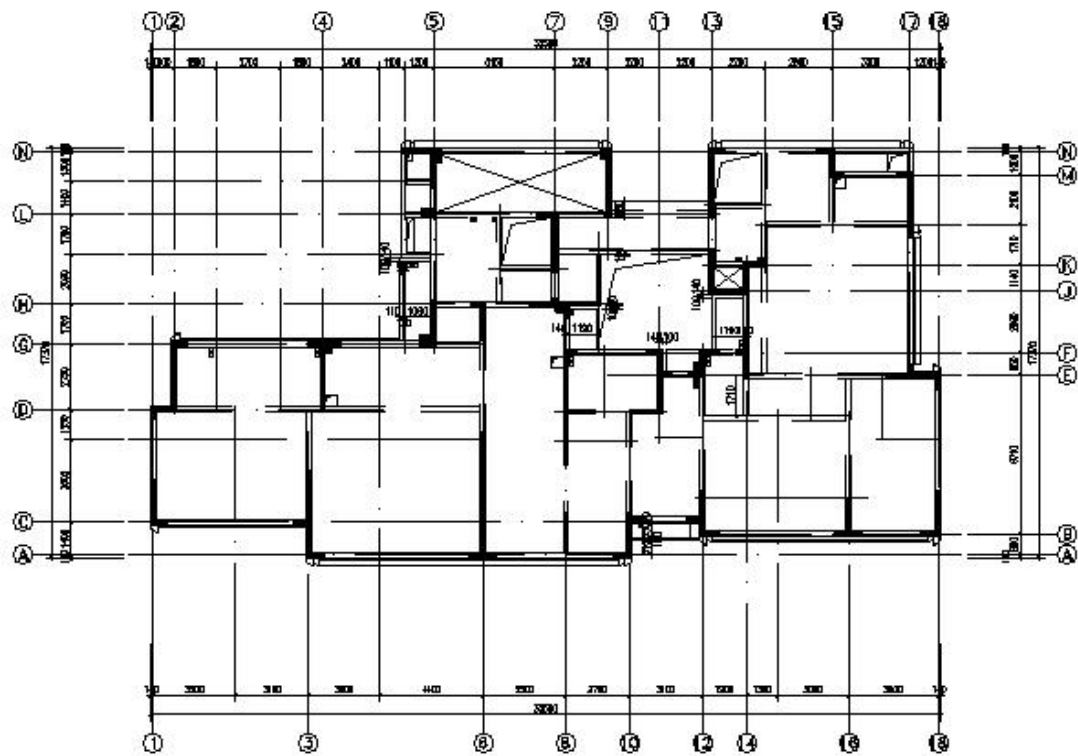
调研楼栋标准层结构平面图（建筑面积约 450 平方）
